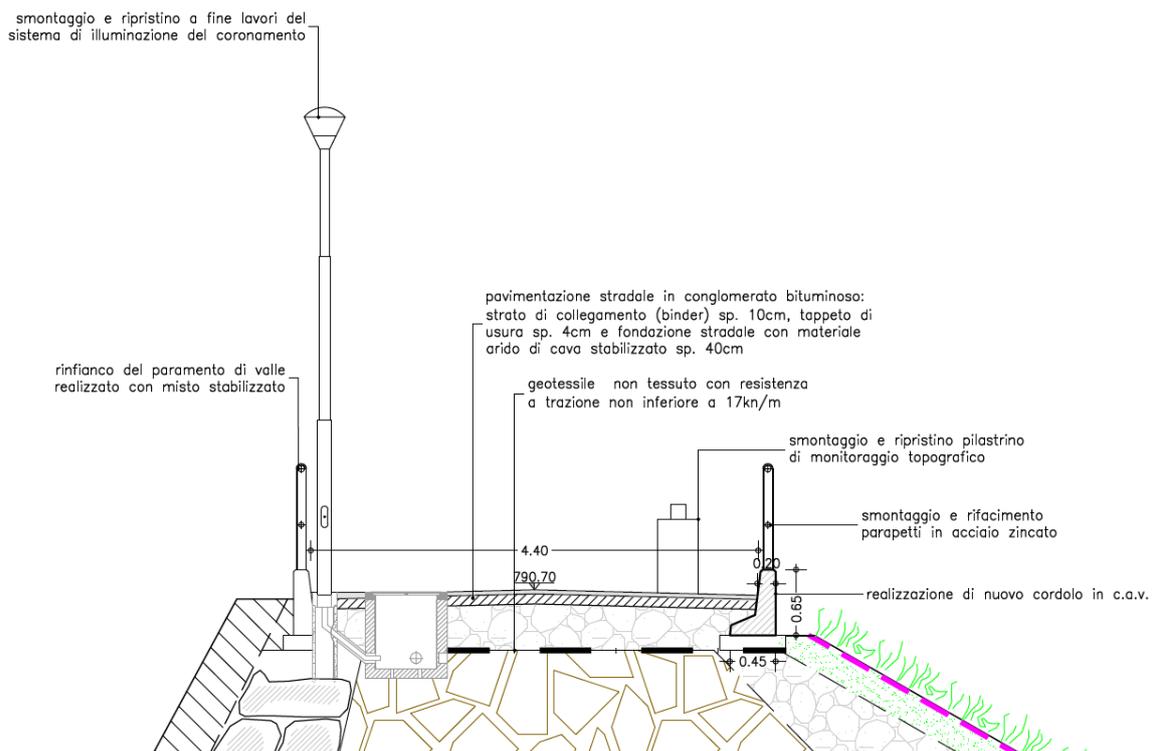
sezione trasversale del coronamento nello stato di progetto.
